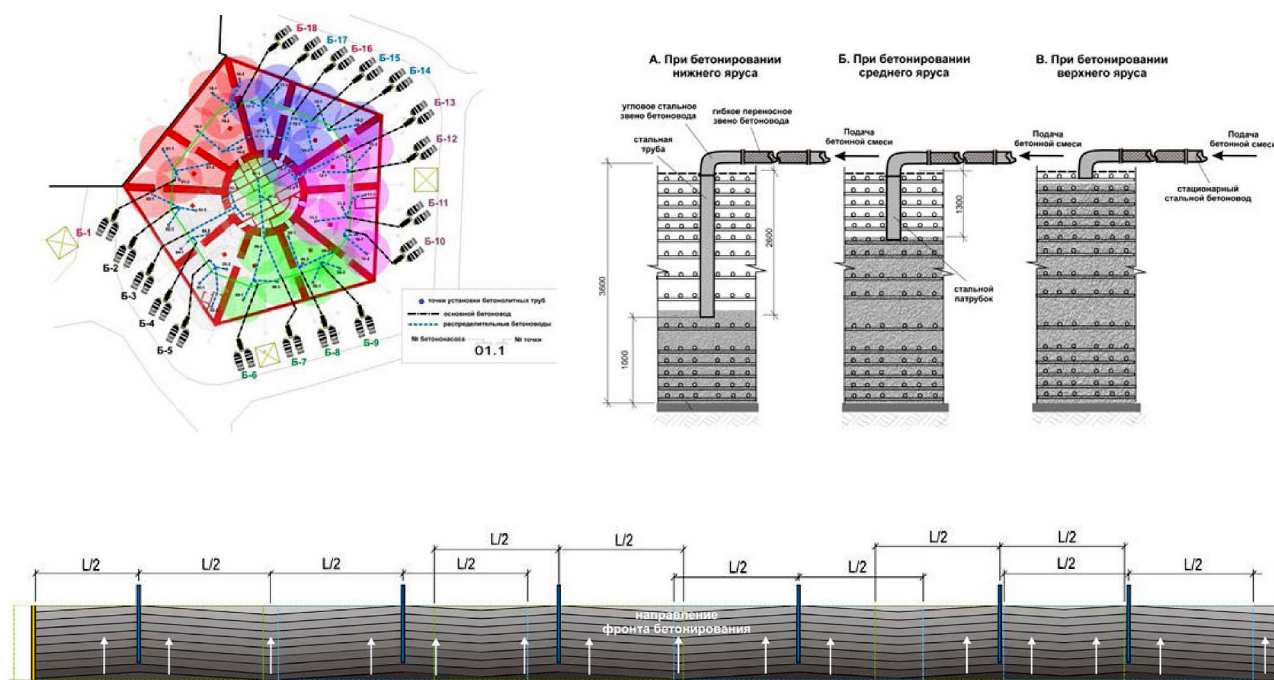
Схема укладки бетонной смеси и направление фронта бетонирования.
